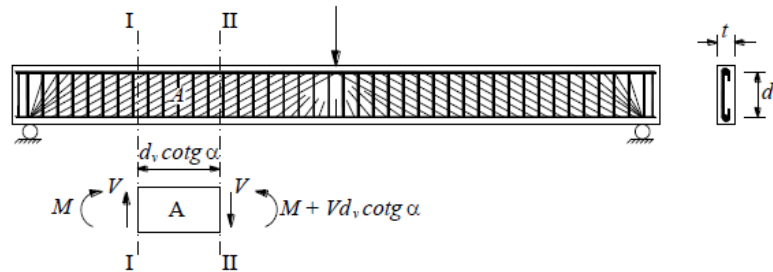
Modelo treliça plana para análise de uma viga de betão armado [9]
